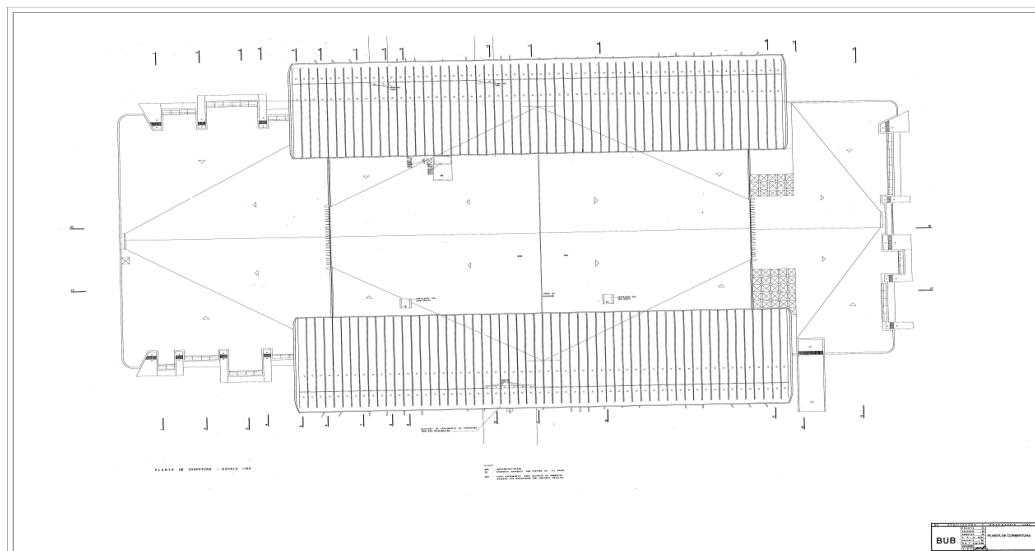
Planta estrutural das lajes de coroamento (CEPLAN).
